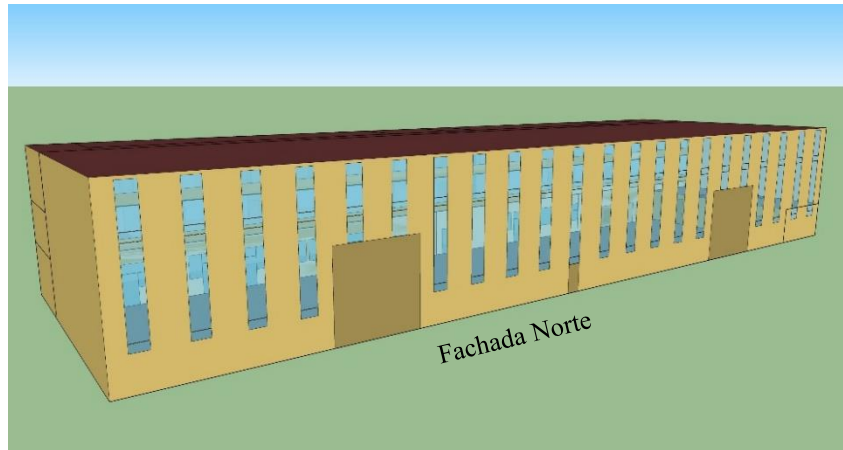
Modelo em 3D do edifício de Componentes. Imagem da fachada Norte (com as janelas) e fachada Oeste.
